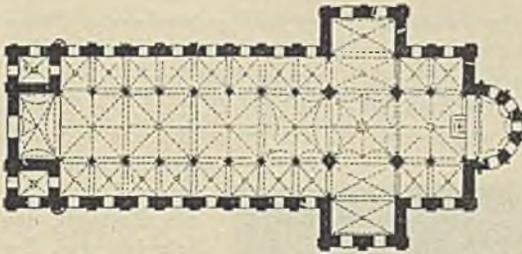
Grundriß von Ste. Trinité in Caen (restauriert)
